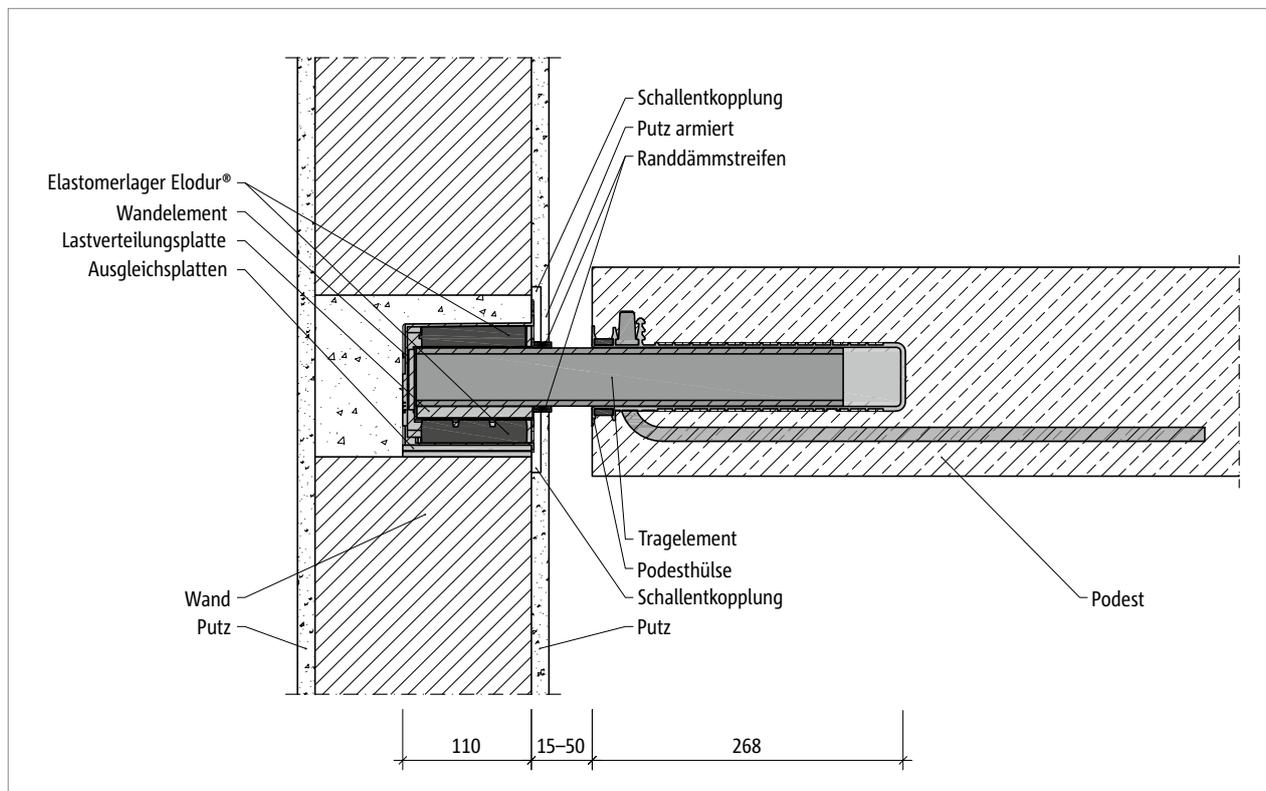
Schöck Tronsole® Typ P: Einbauschnitt mit Ortbetonpodest und Luftfuge
